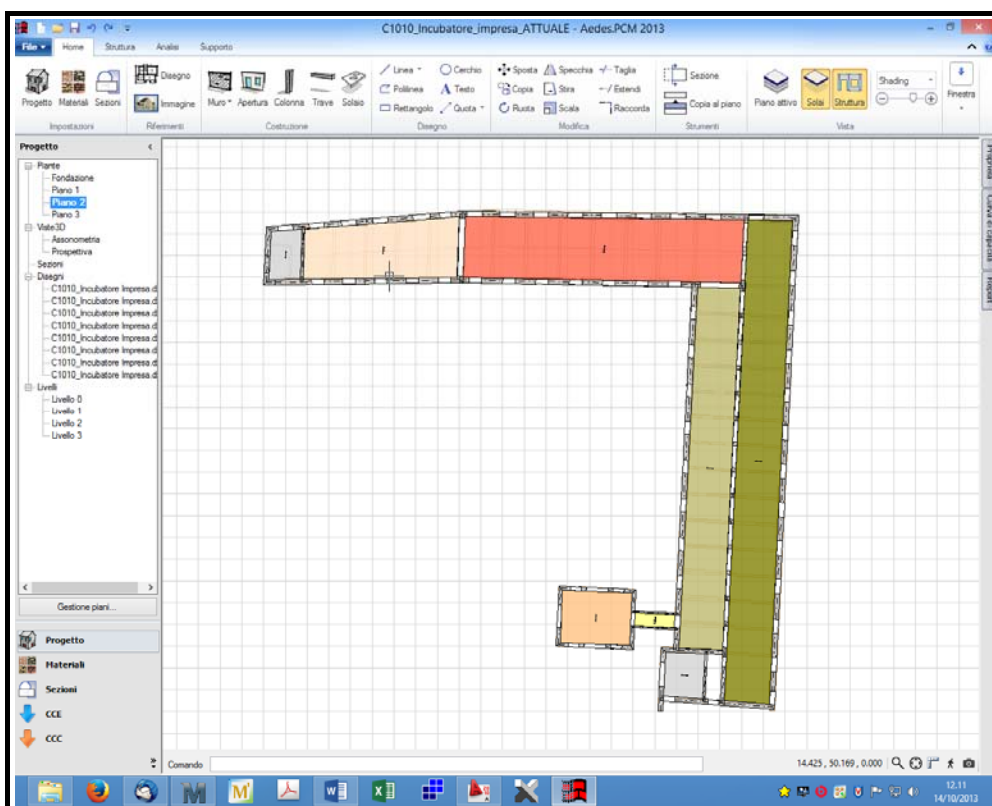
Modello PCM 2013 - Pianta Piano Secondo
